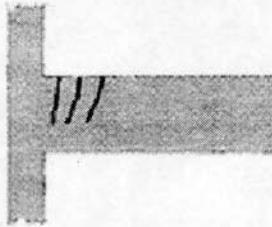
Fisuras de flexión en la parte superior (marquesinas, balcones)
